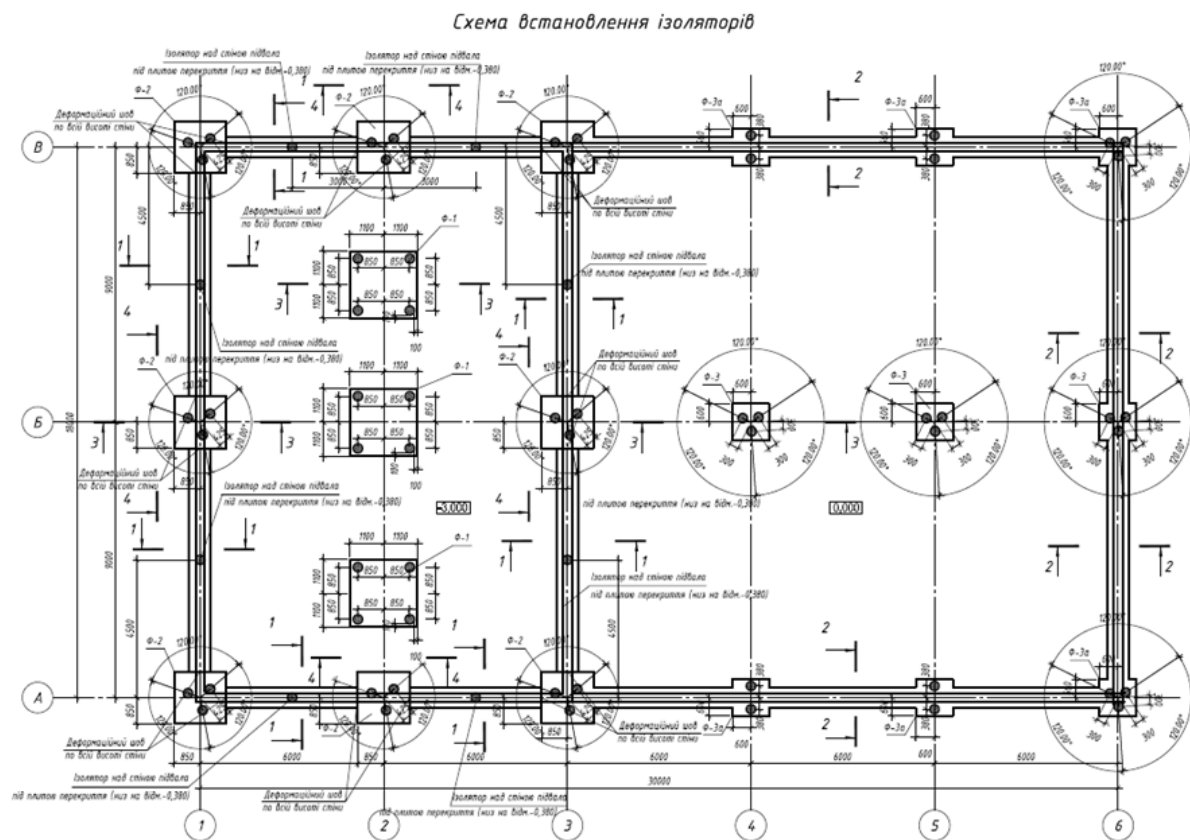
Розміщення ВІ на фундаментах та стінах будівлі ТЦ
